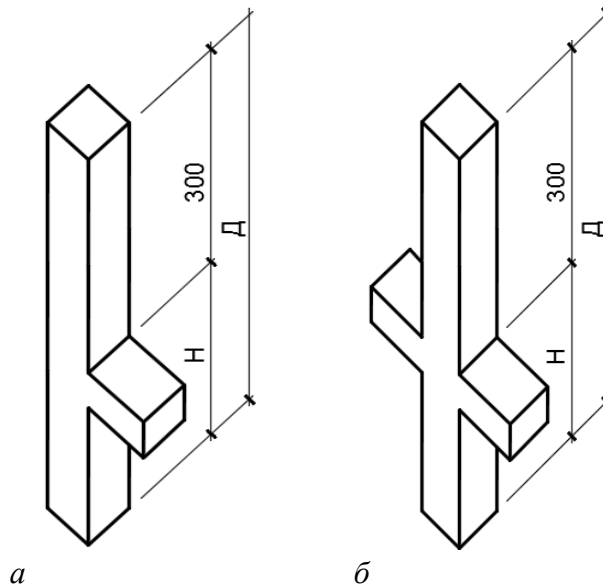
Колонны железобетонные с консолями (на один этаж):
